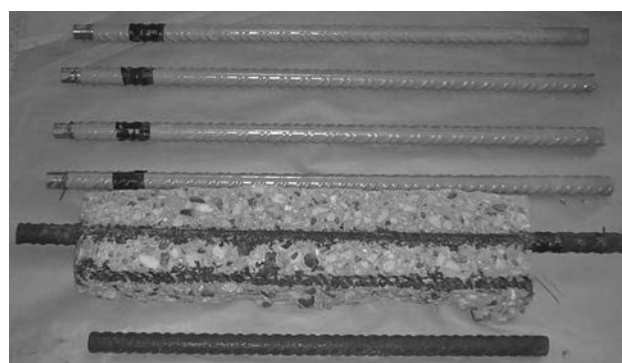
Estado de las seis barras tras el ensayo de corrosión acelerada en la losa con barras de diámetro 25 mm
